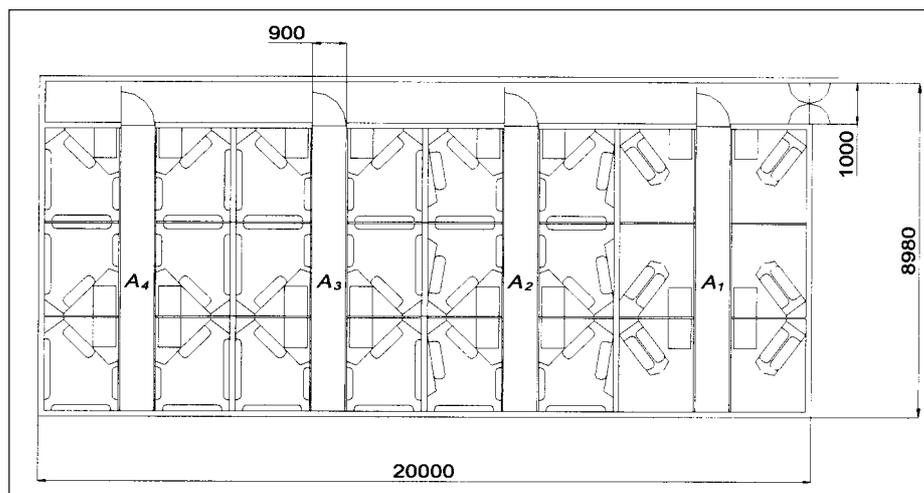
Grundriss des Abferkelbereichs (Maßangaben in mm); A₁, konventioneller Kastenstand; A₂, Kastenstand zum Öffnen; A₃, A₄, Bewegungsbuchten.
